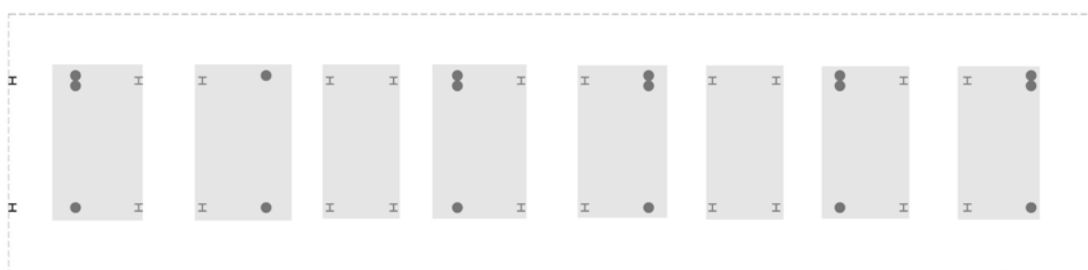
Planta do pavimento térreo - locação de pilares em perfil I do mezanino.
